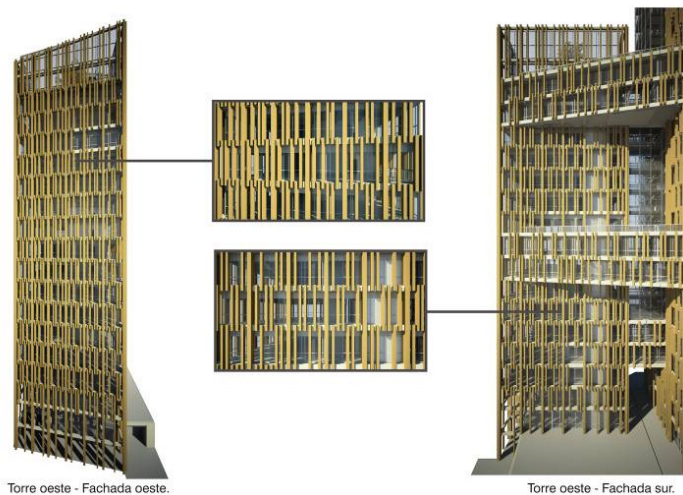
Disposición de los elementos verticales en Fachada Oeste y Fachada Sur de la Torre de Oficinas Oeste. Proyecto Centro Cívico Plaza de La Libertad, Medellín.
